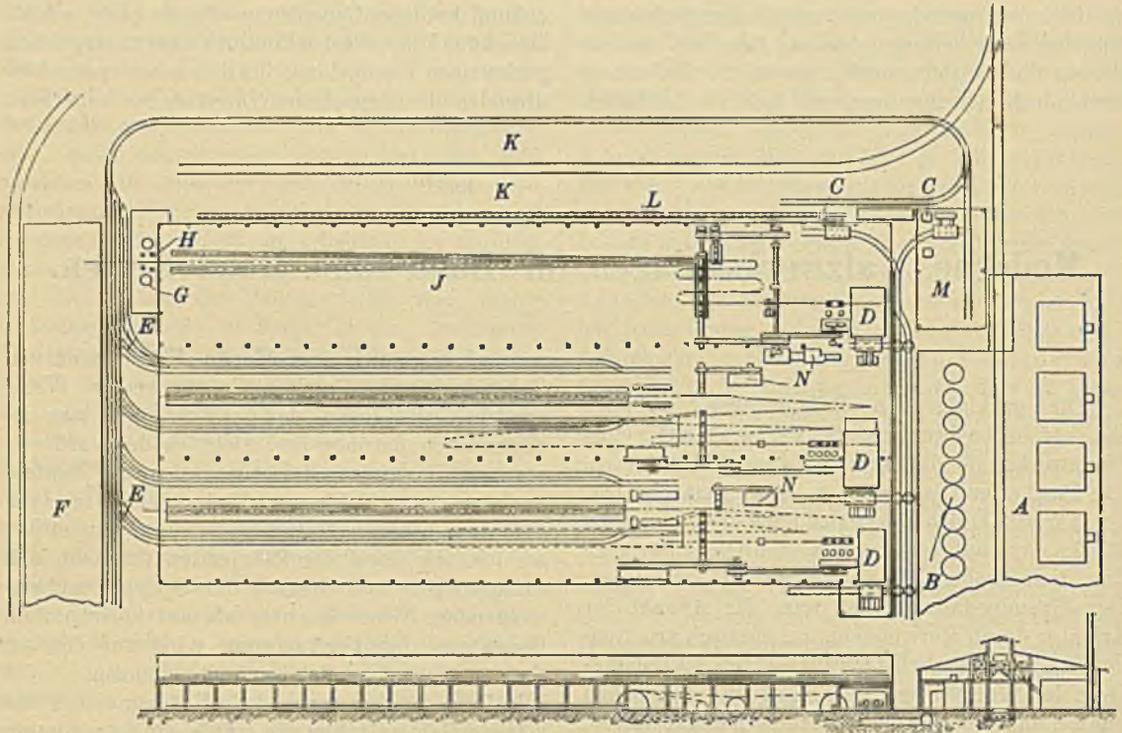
Plan eines Walzwerks für Band- und Handelseisen.
